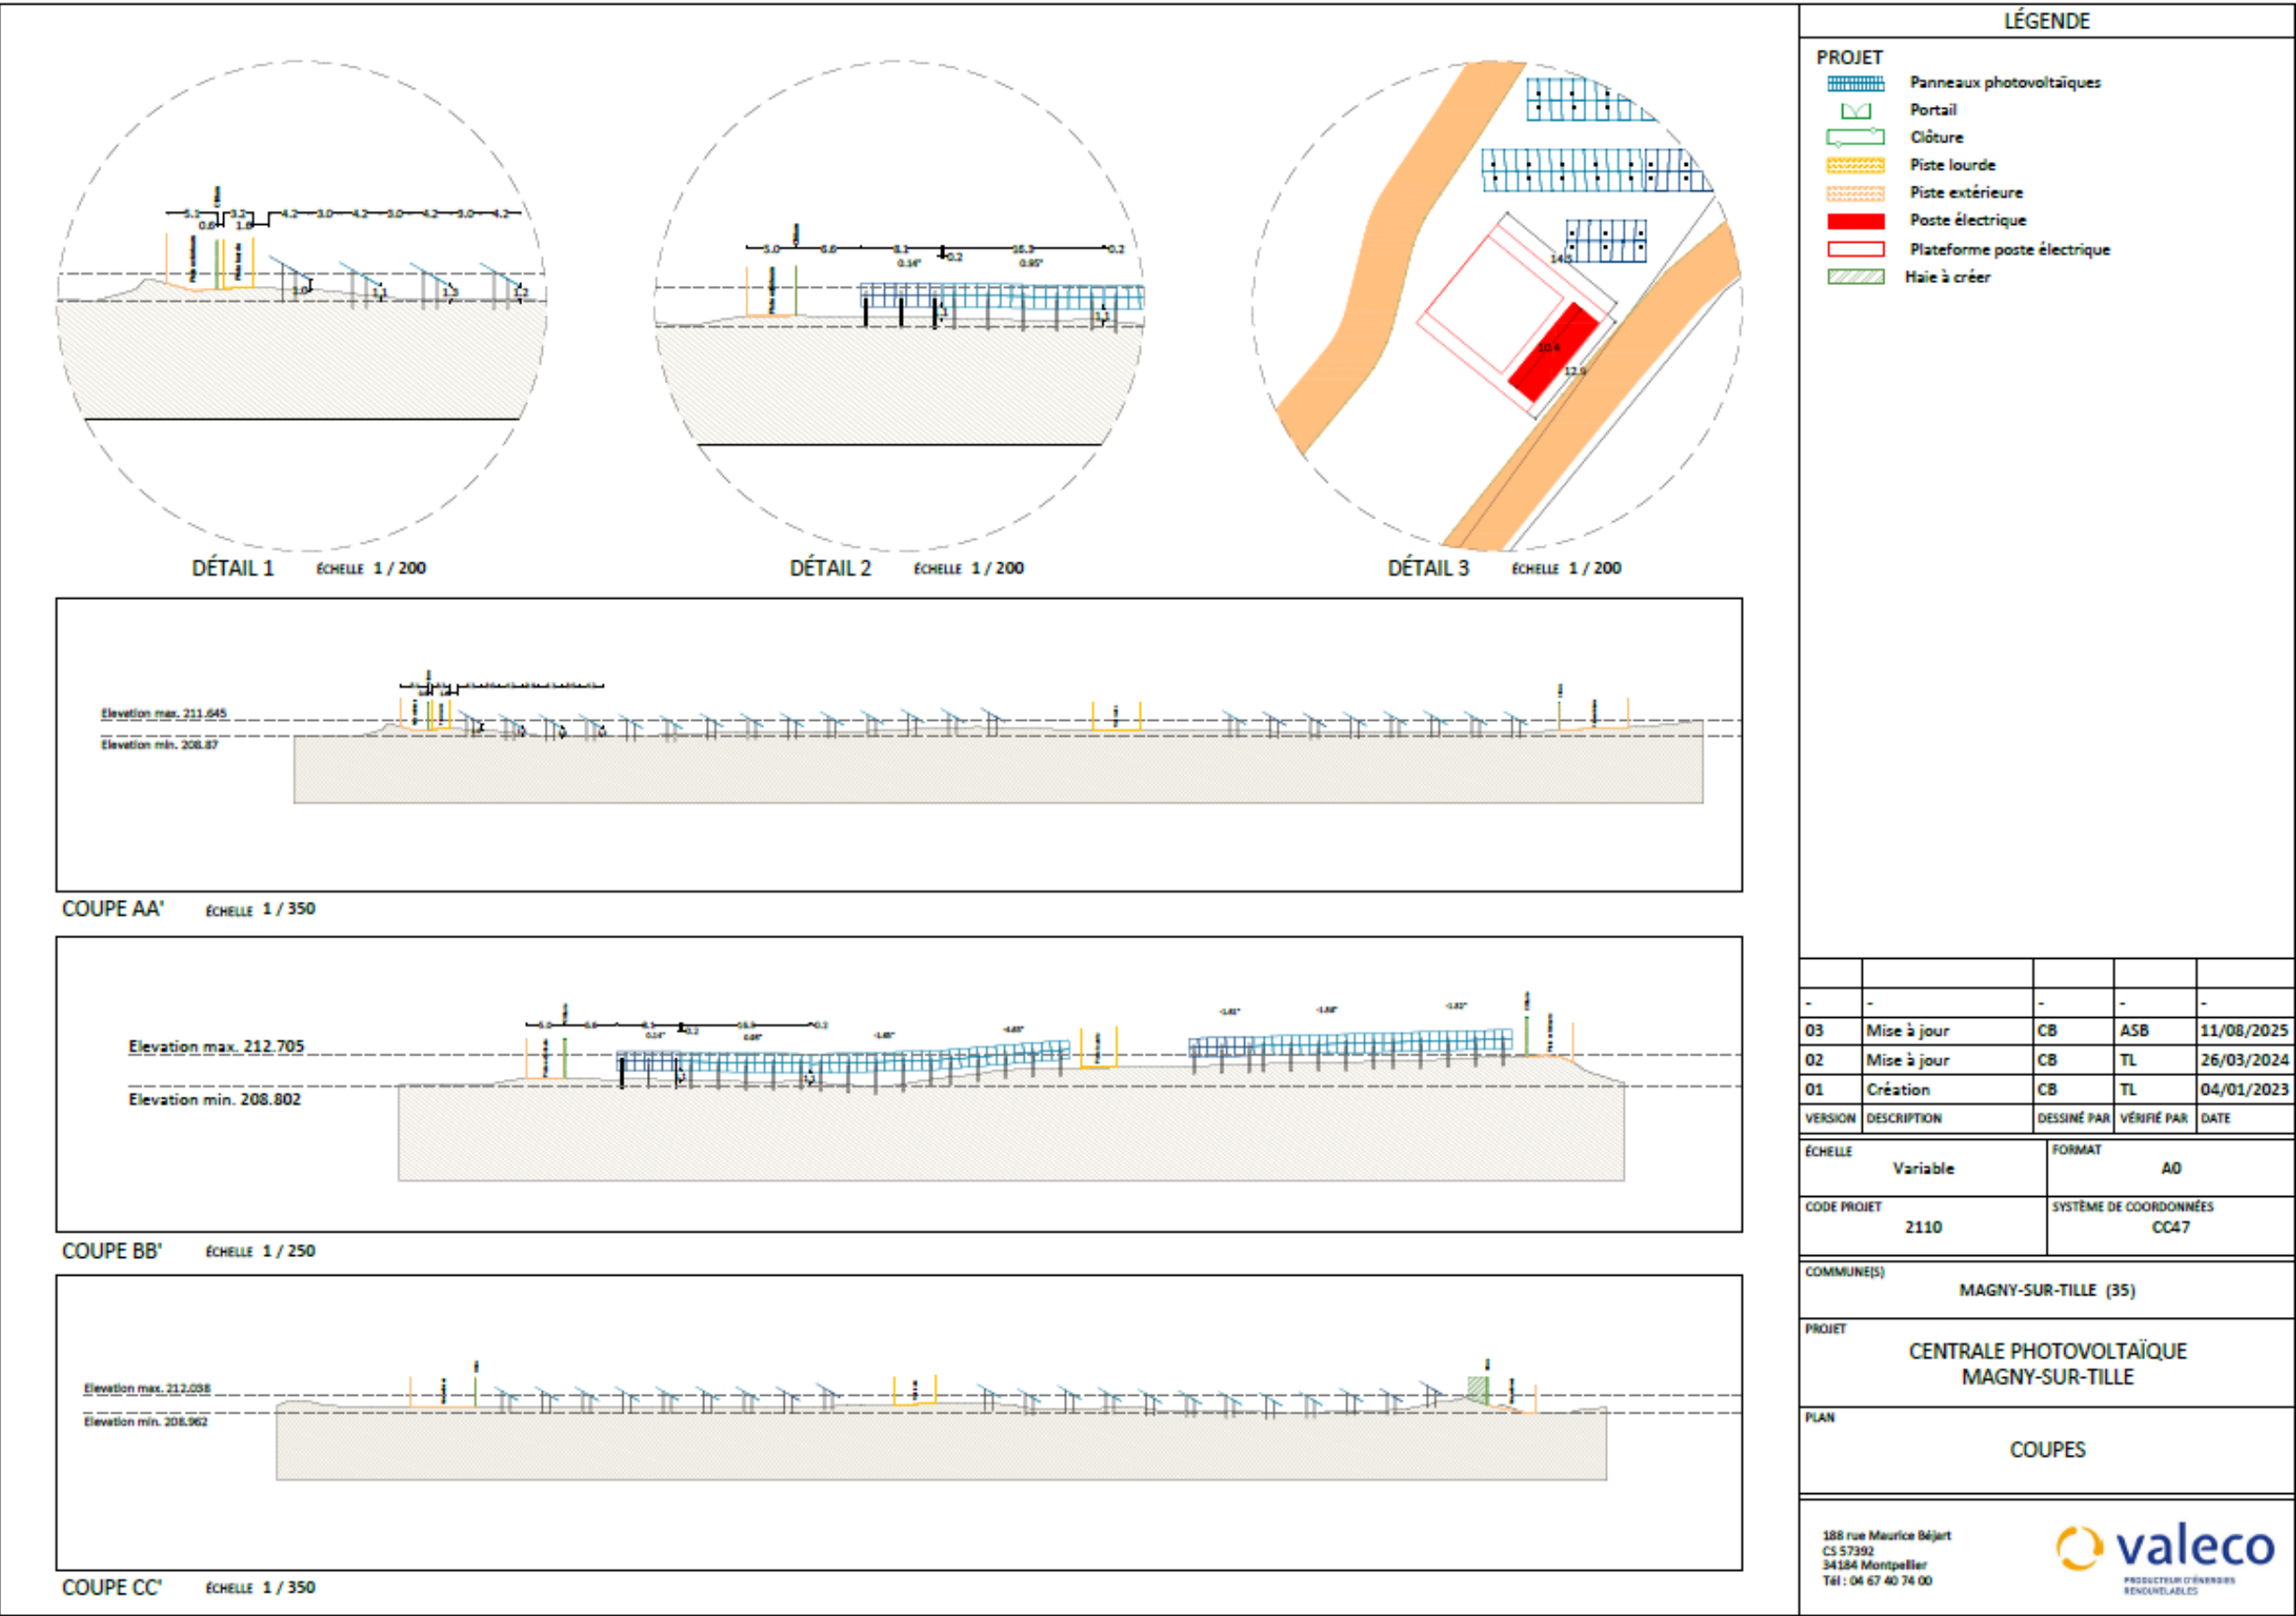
reproduction du plan de coupe du projet (vous trouverez en annexe un grand format du plan)
